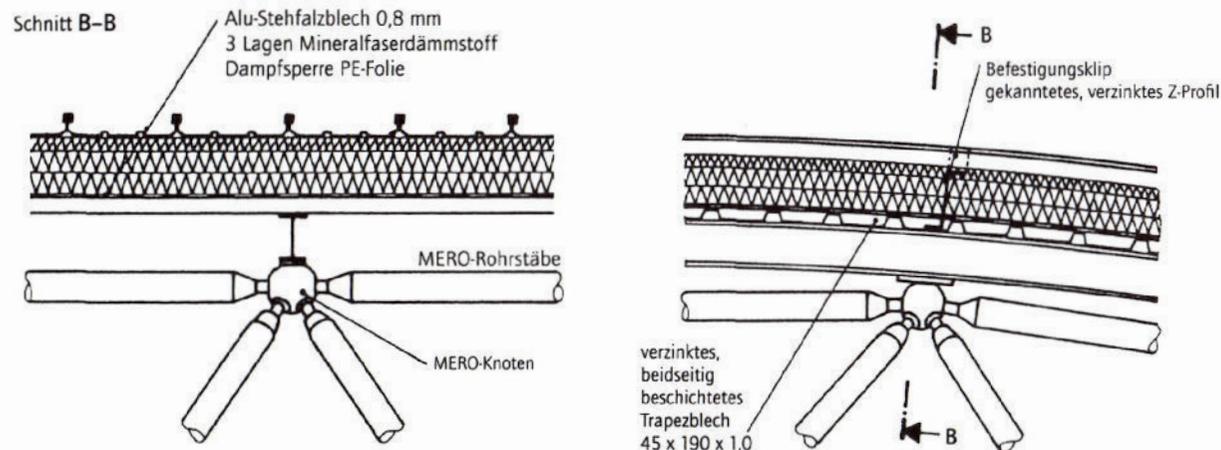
Münsterlandhalle, Münster, Detail der neuen Tragkonstruktion
